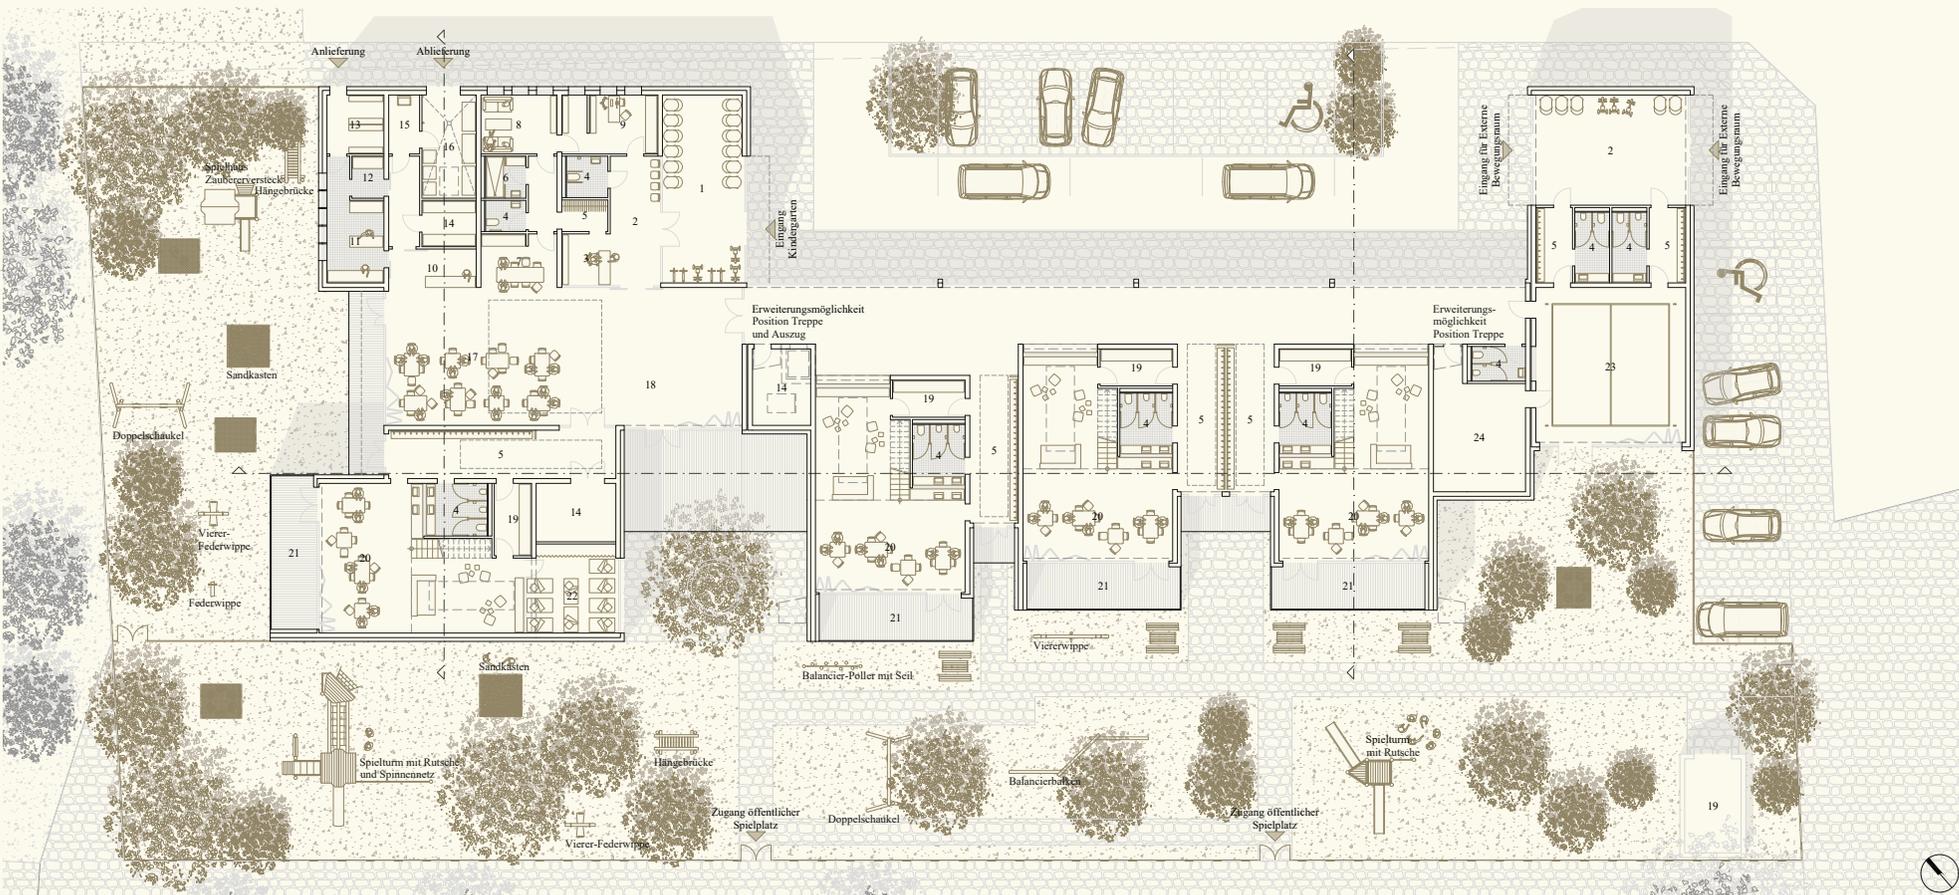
, Grundriss Erdgeschoss | 1:400
